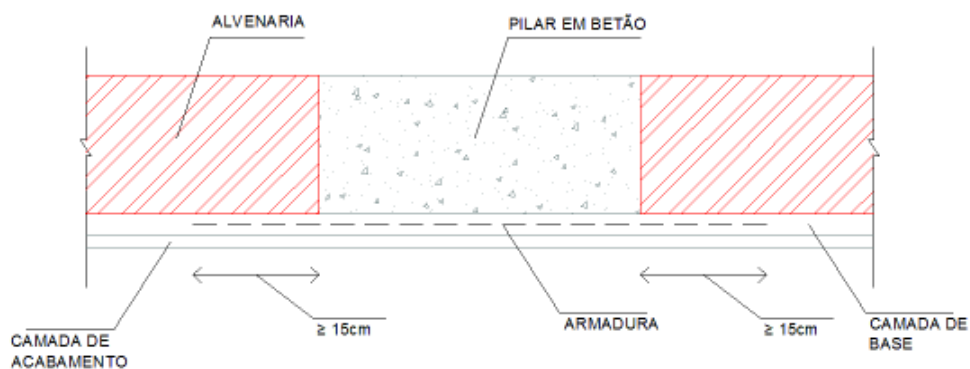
Ligação betão – alvenaria (armadura de reforço) [11]
